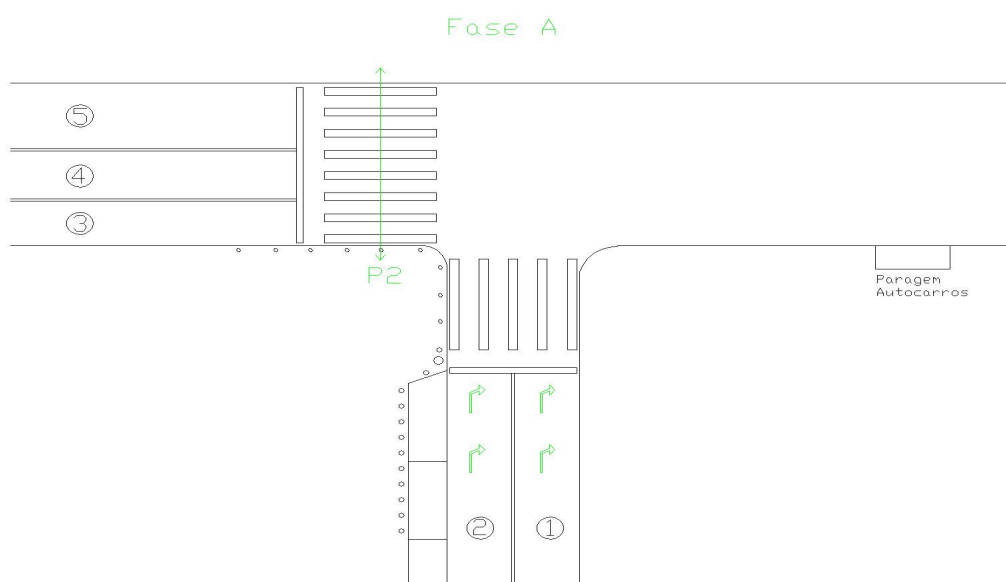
PLANO DE REGULAÇÃO – FASE A
